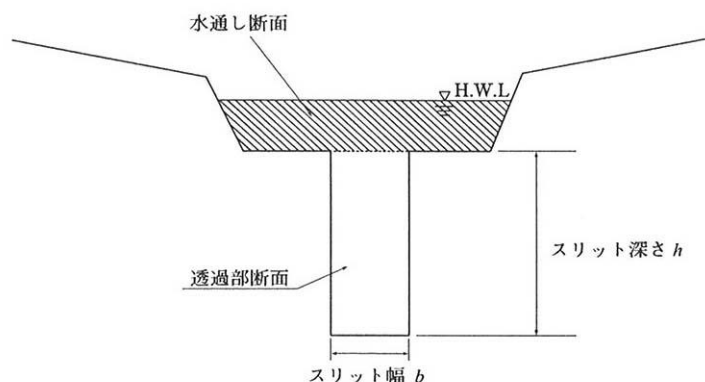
コンクリートスリット砂防堰堤の水通し断面と透過部断面
